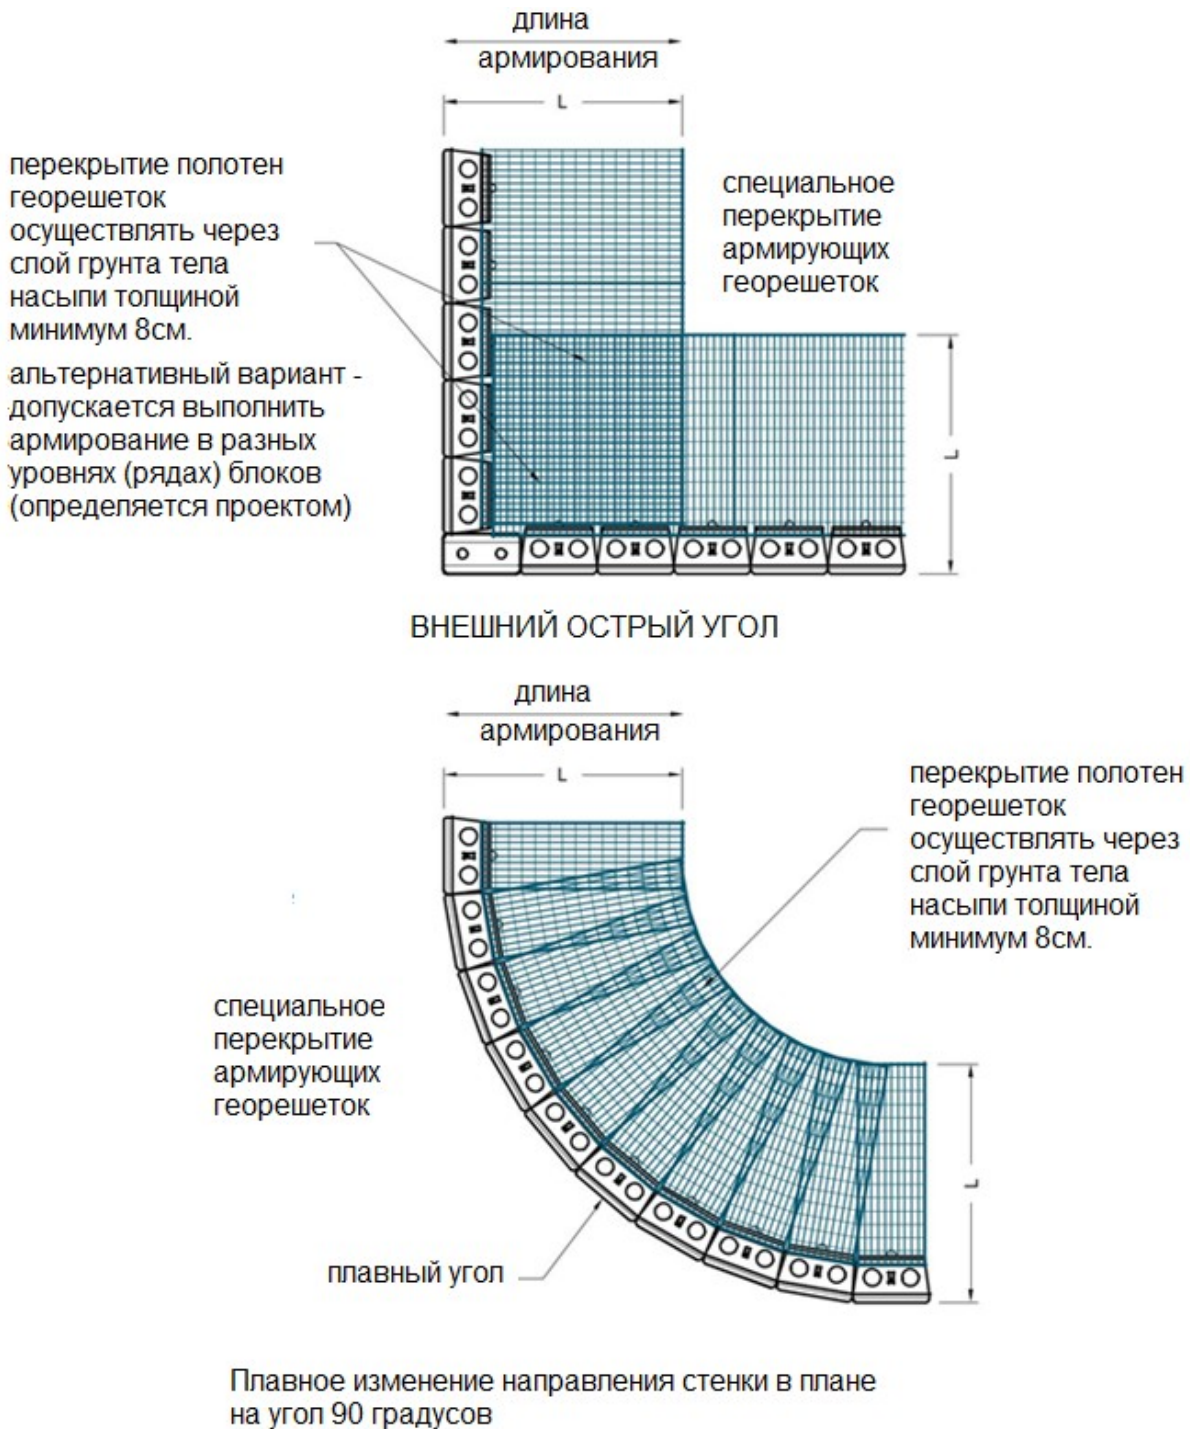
Расположение армирующих георешеток в стенках типа АГ 2 с внешними углами поворотов в плане
